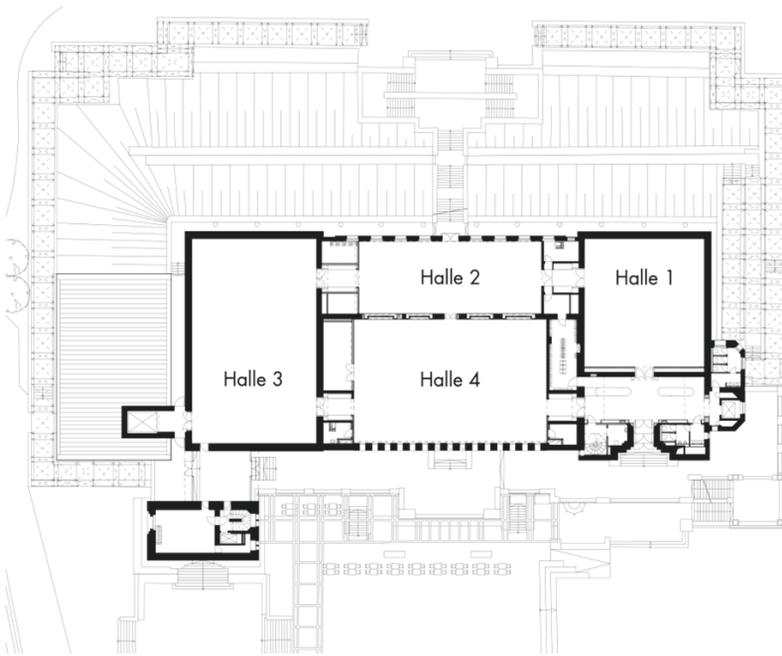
Erdgeschossgrundriss der Eingangshalle und der vier Ausstellungshallen (Quelle: schneider + schumacher).
